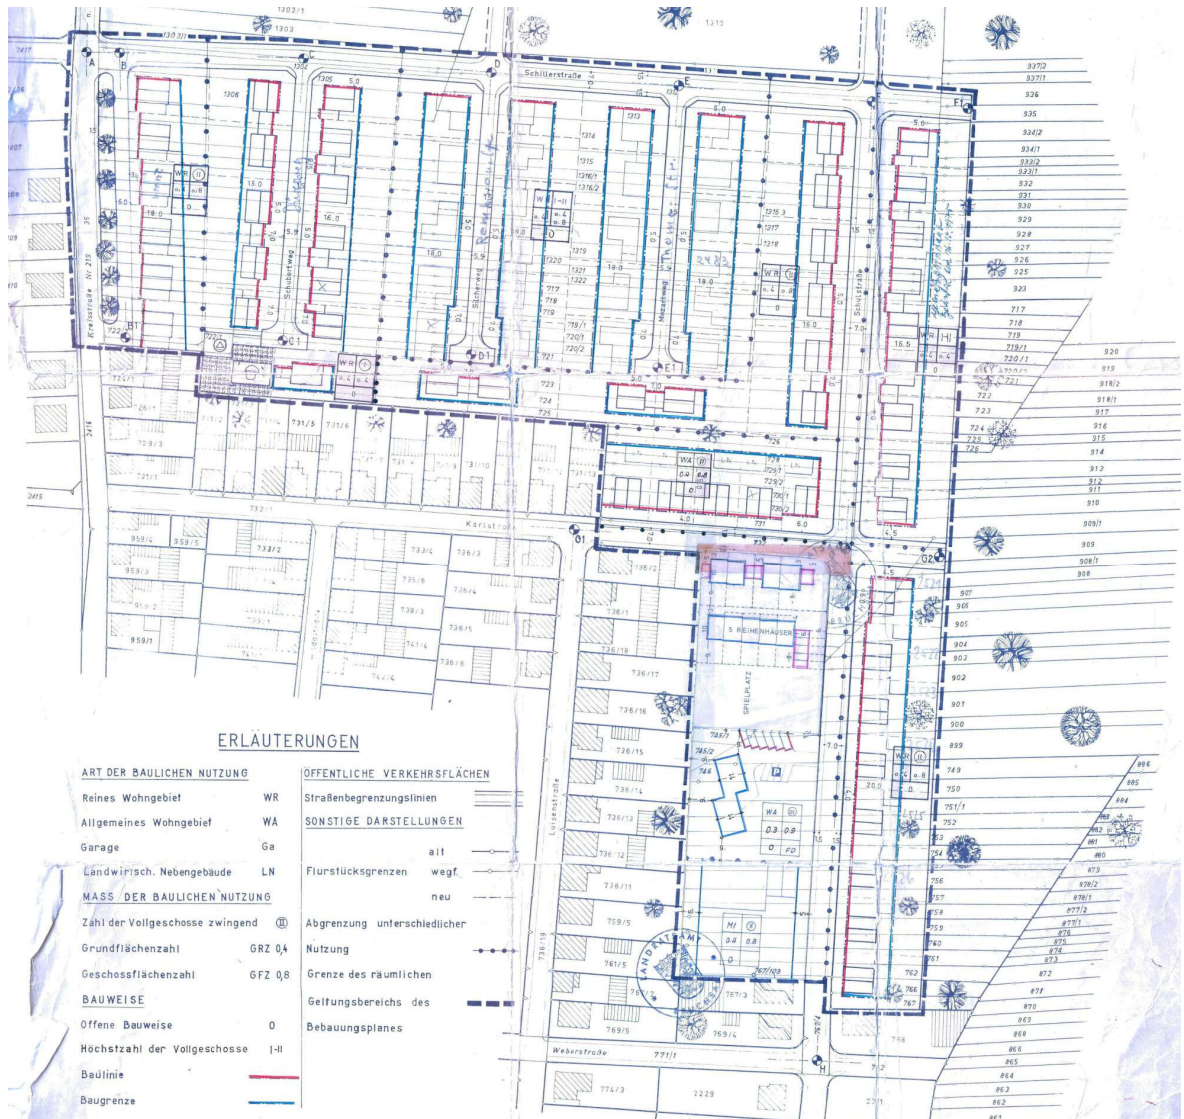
Bebauungsplan „Pfad“, Urfassung 1970
